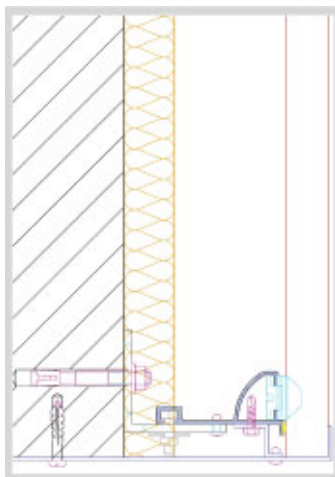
Aplicação da fachada ventilada – Secção horizontal lateral [47]
